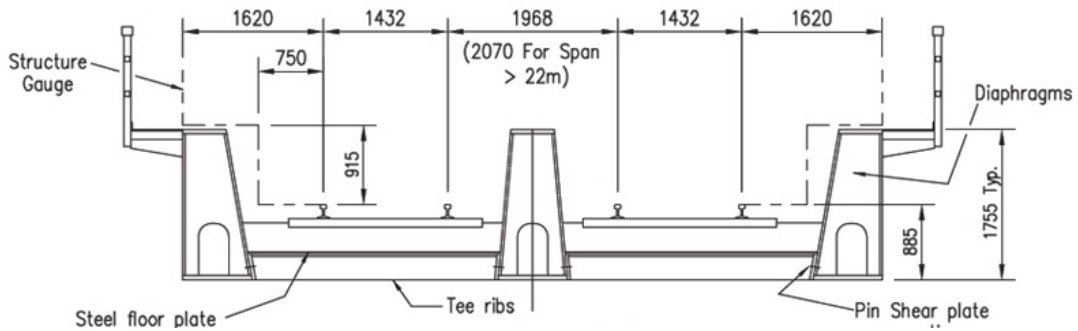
Caixão típico da Network Rail (www.steelconstruction.info)
